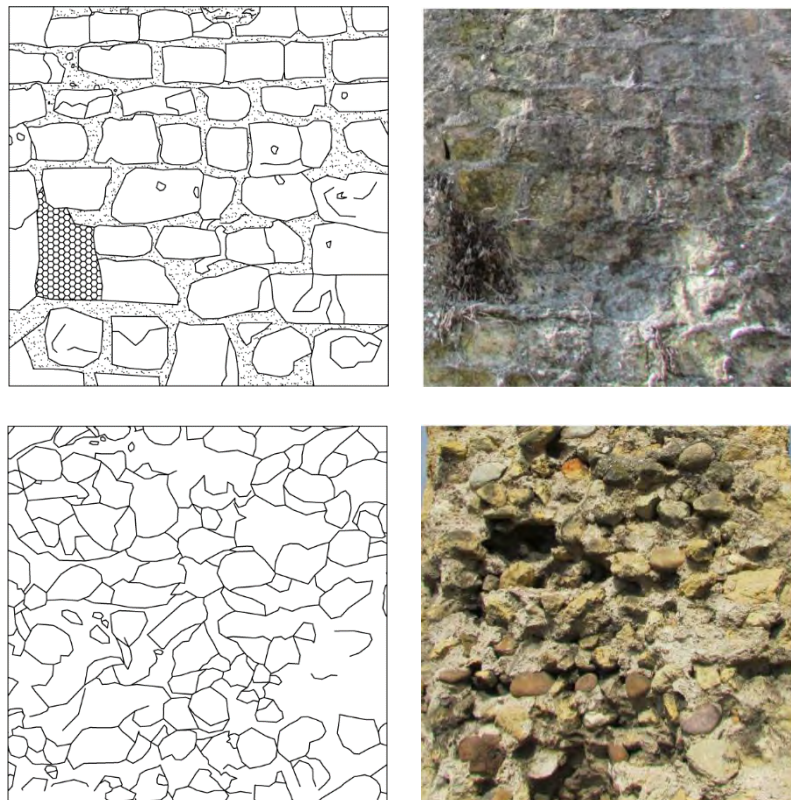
Prospetto e sezione del paramento del setto B1
